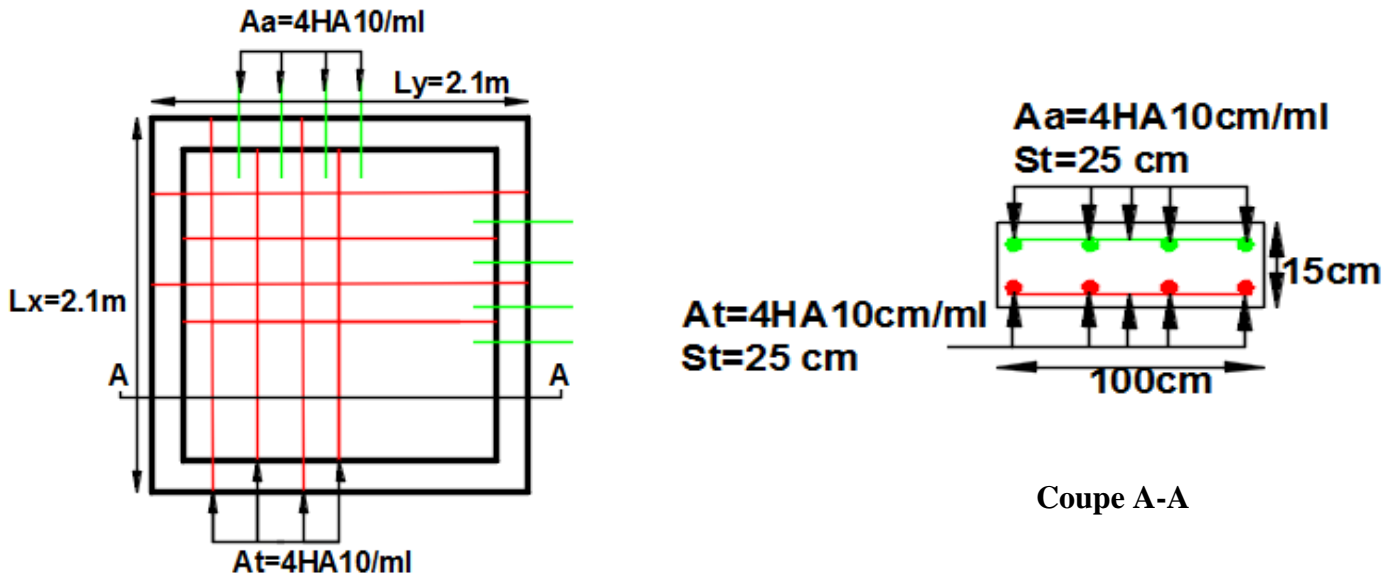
Schéma de ferrailage de la dalle pleine au-dessous de l'ascenseur
